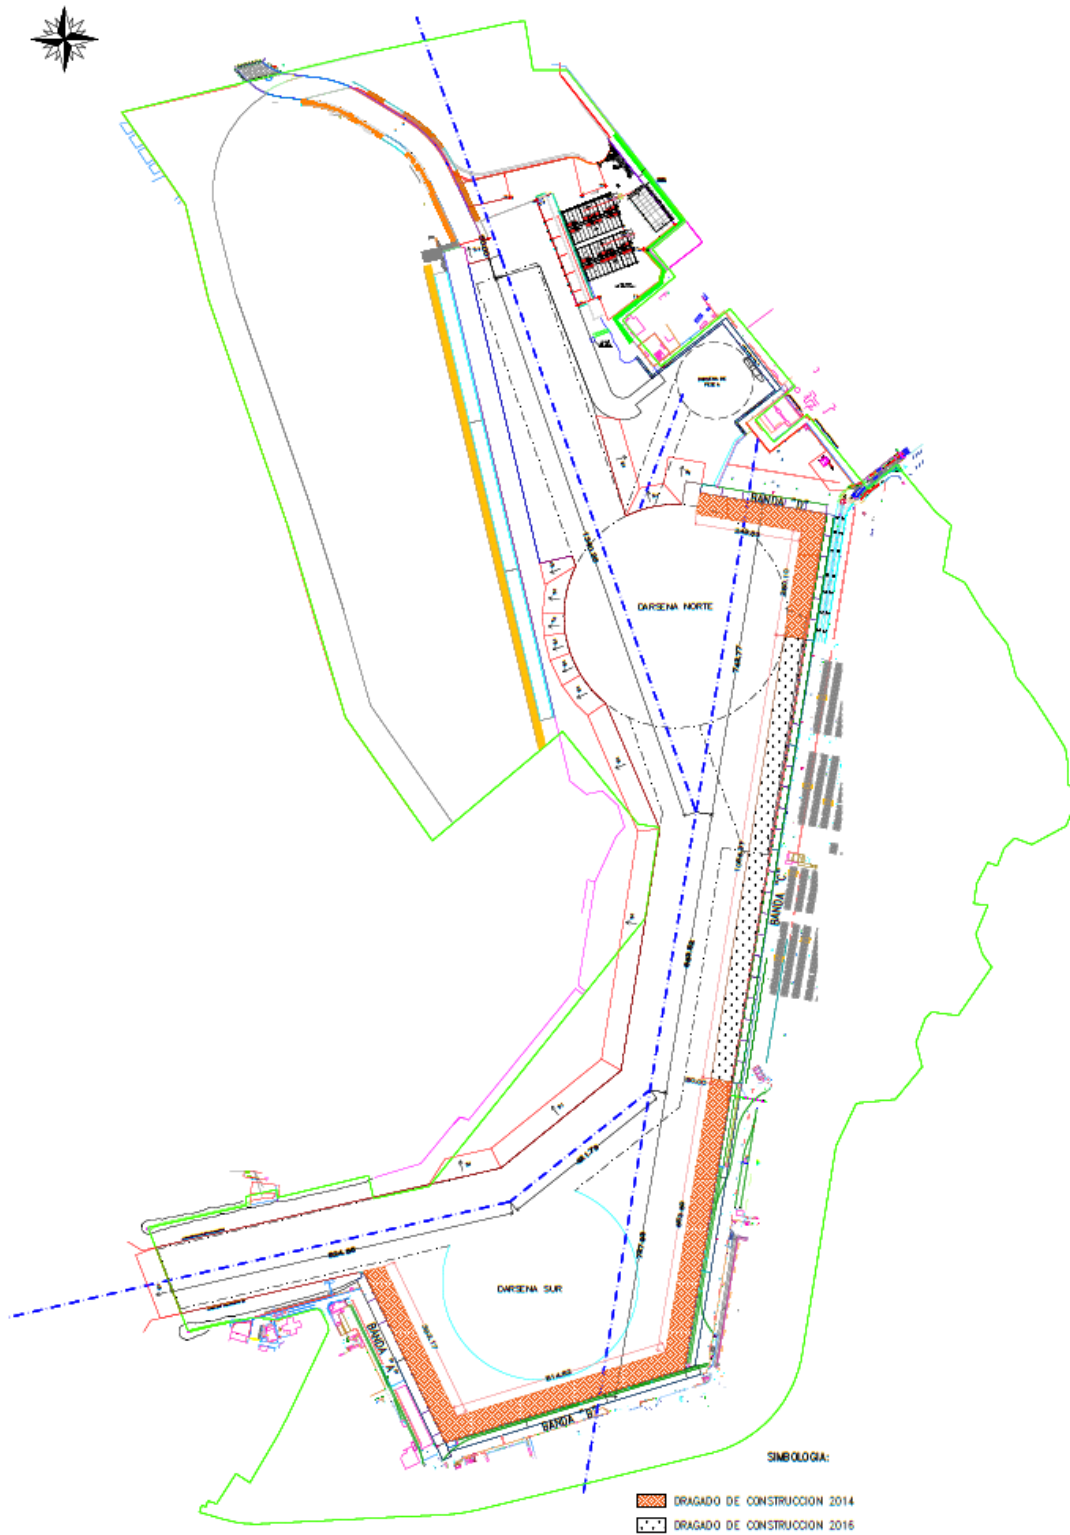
2. Croquis de dragado de construcción en el Puerto Interior de San Pedro, Manzanillo, Col.
